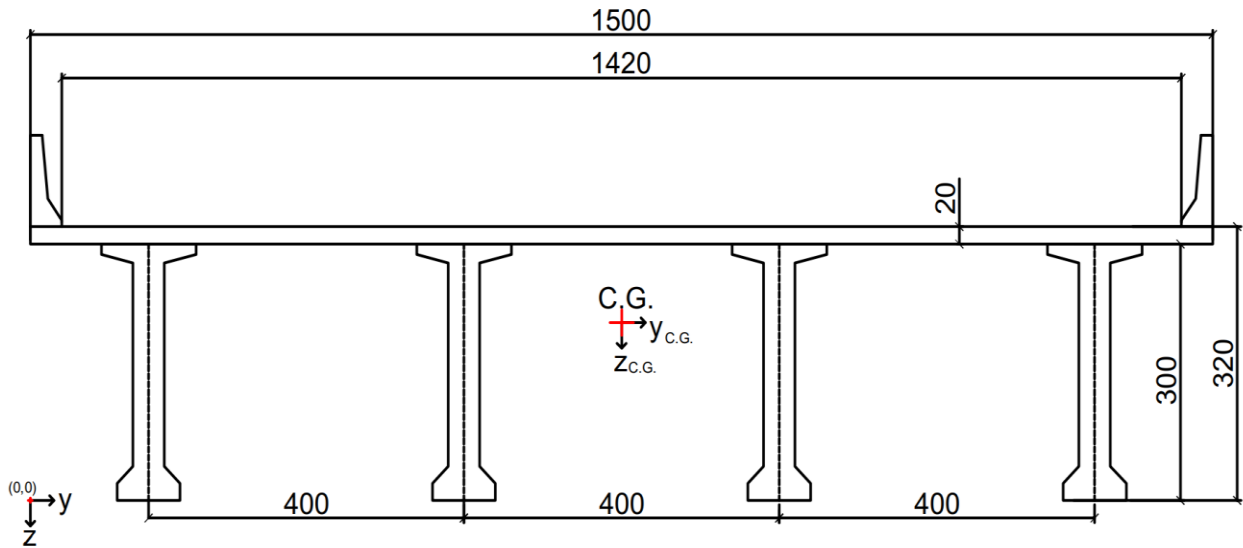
Seção transversal em vigas T pré-moldadas (seção 01). Fonte: Autor
